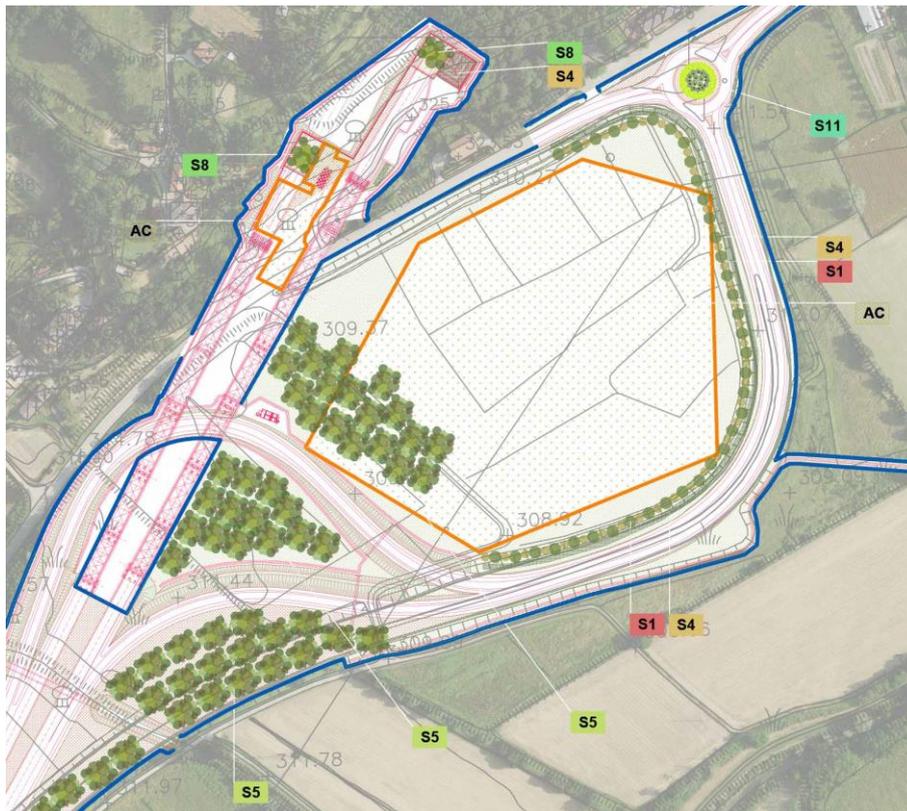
Stralcio della planimetria con area di cantiere in prossimità dello svincolo Le Ville
